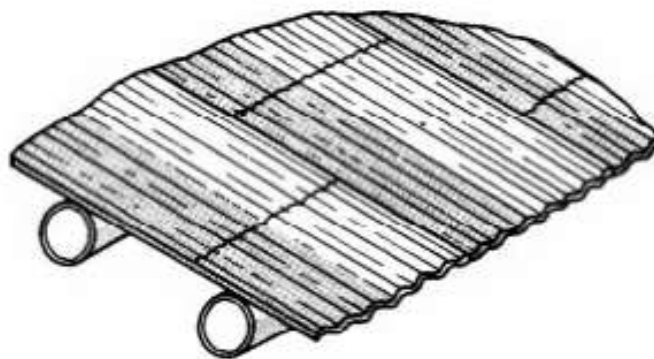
Esquema de pavimento de placas de bambu desenrolado [10]
